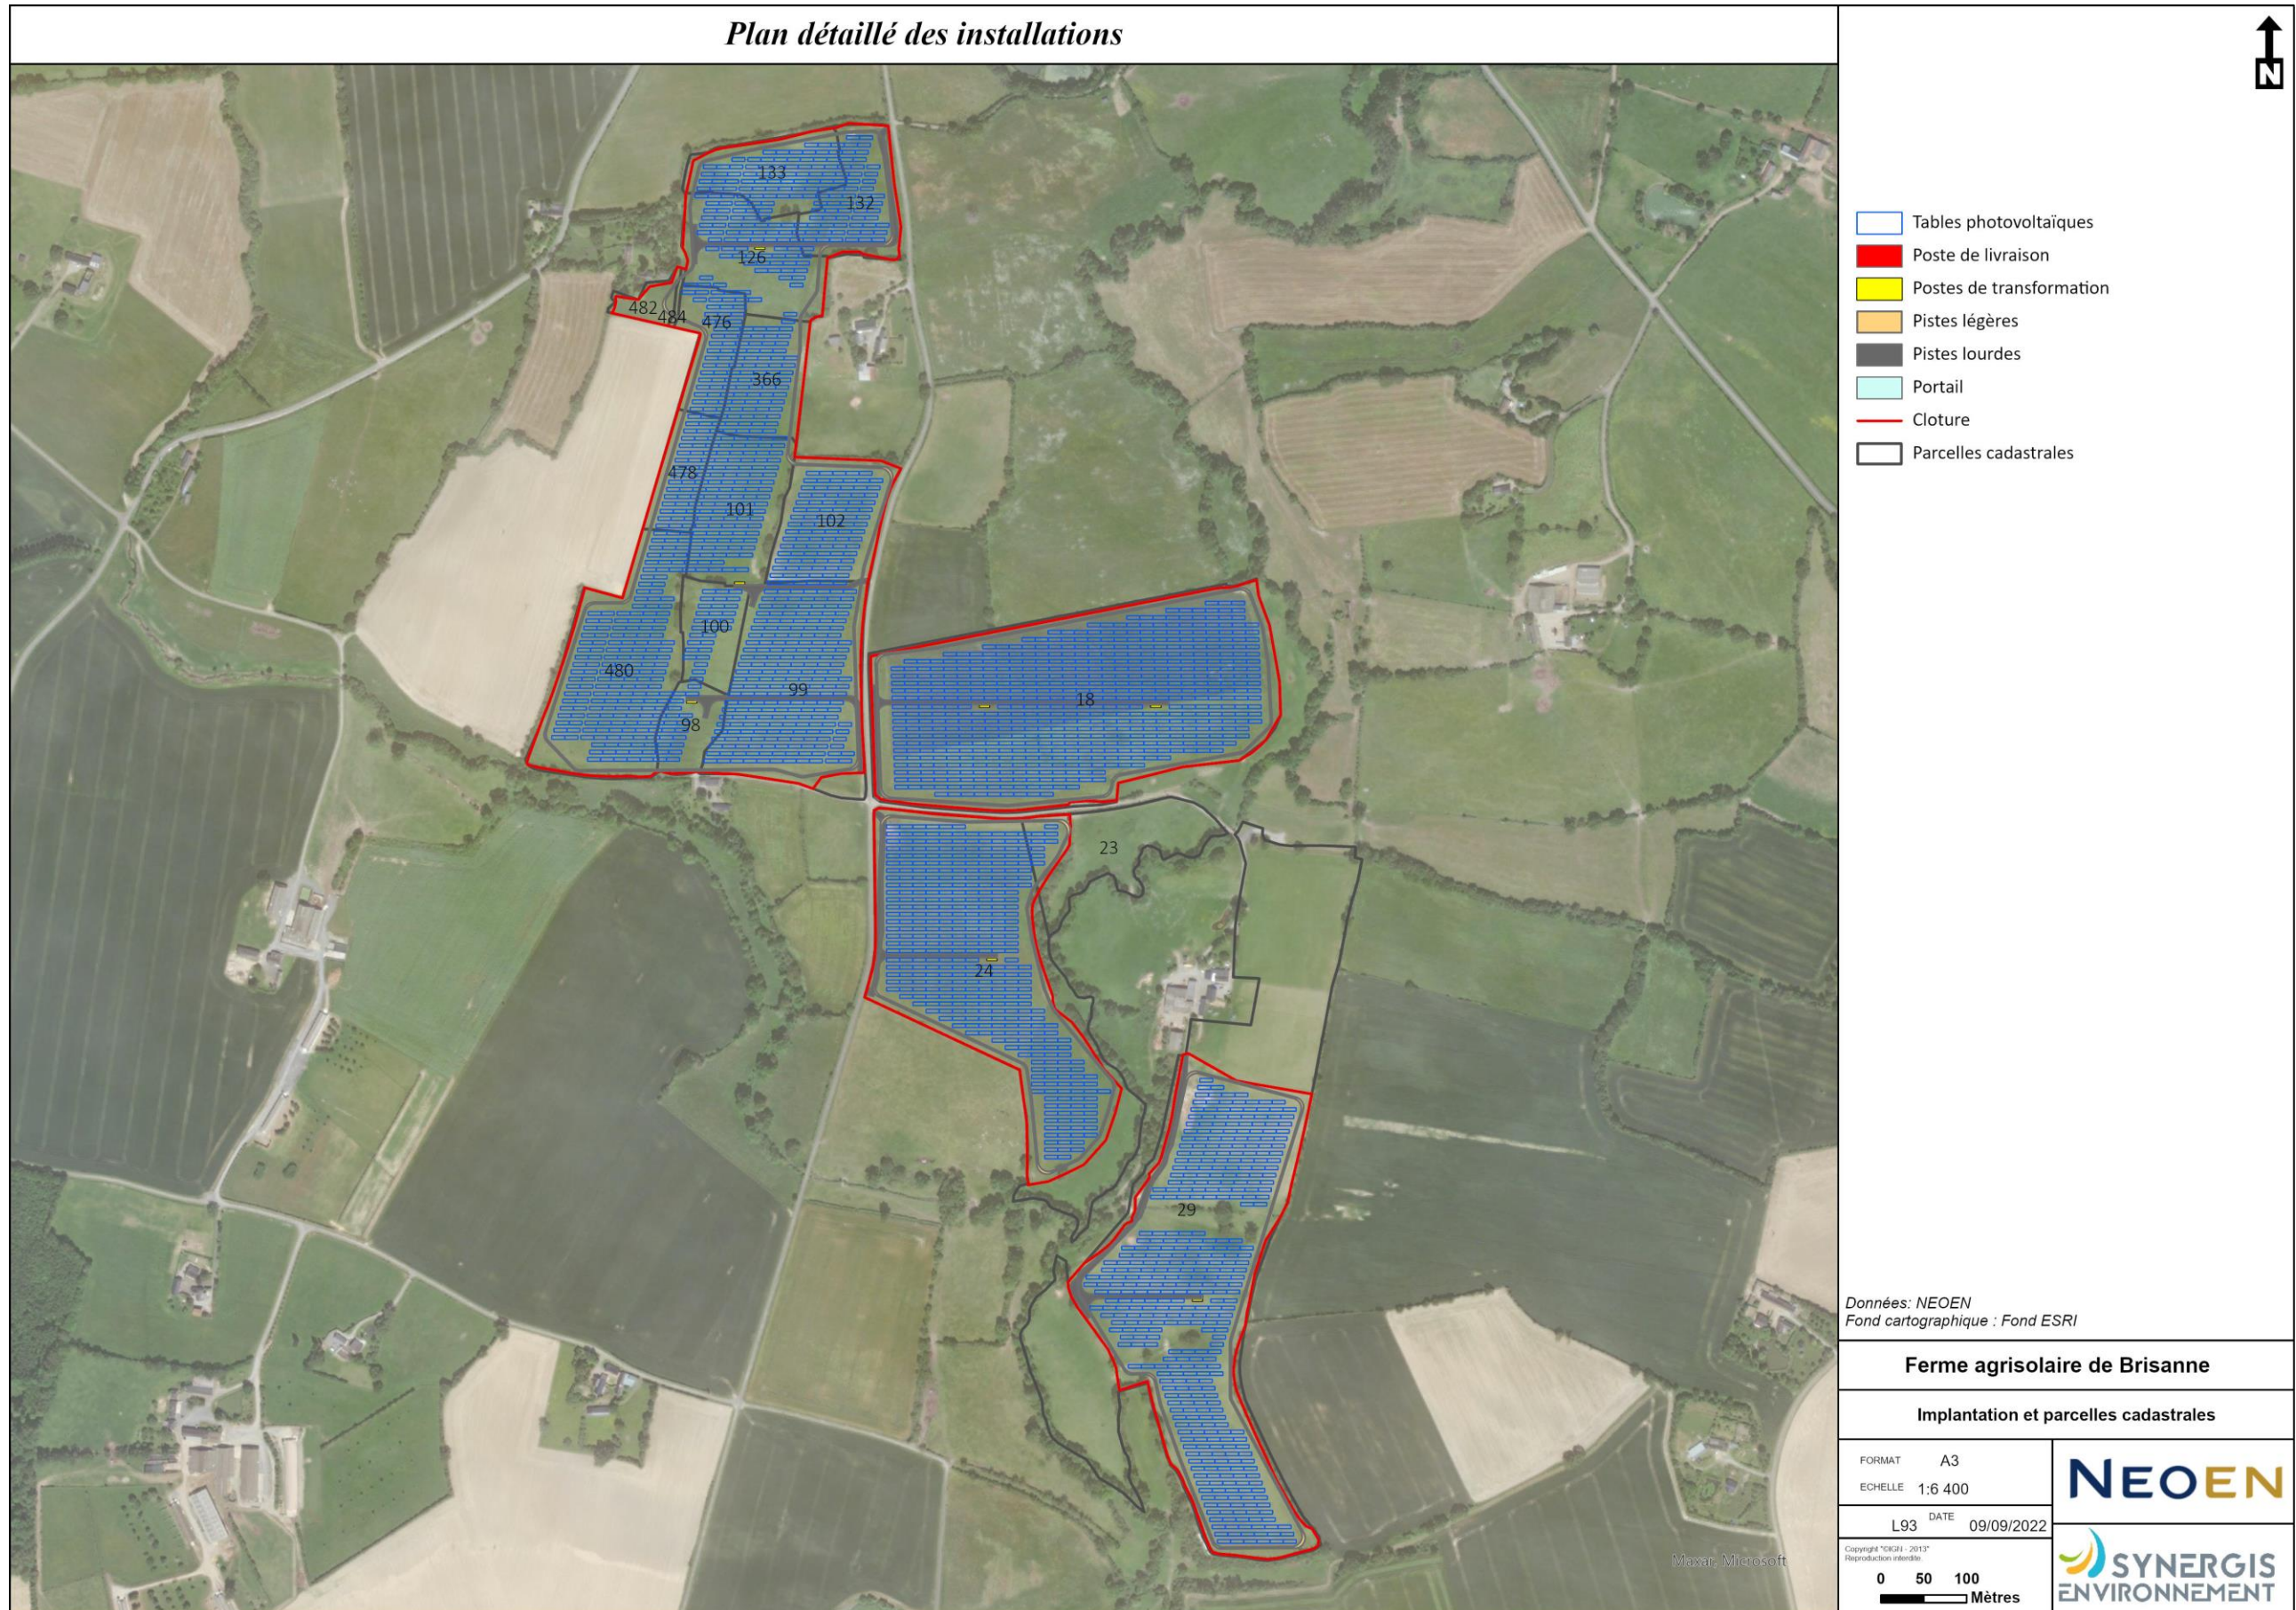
Plan détaillé de l'installation et parcelles cadastrales
